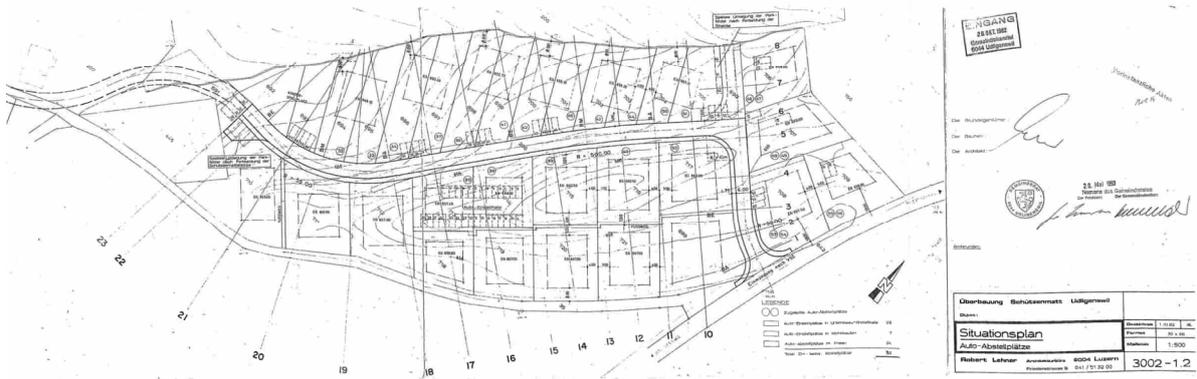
Plan Baubereiche und Auto-Abstellplätze
